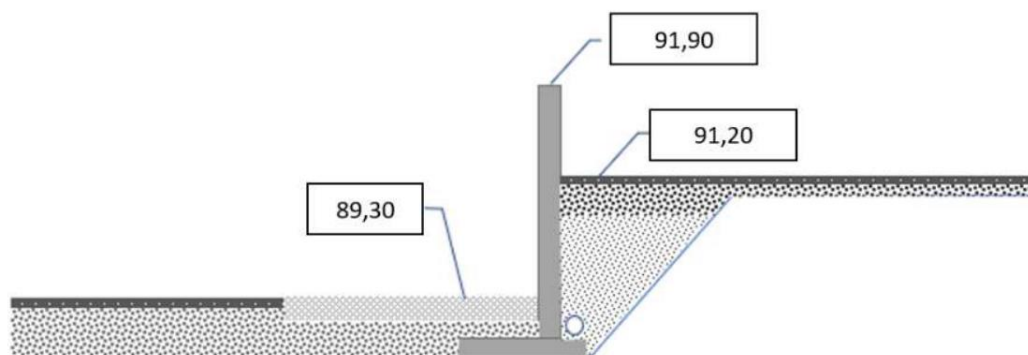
Plan schématique en coupe du quai de la déchèterie
